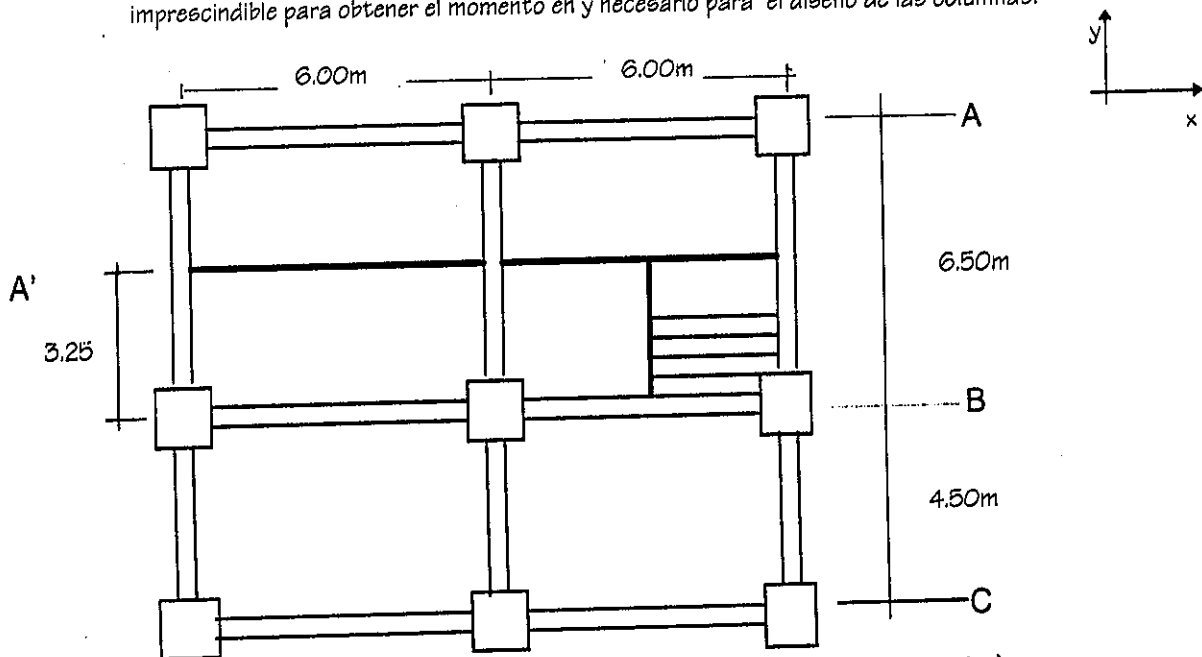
PLANTA DE LA ESTRUCTURA (Sin escala, dimensiones a ejes)
